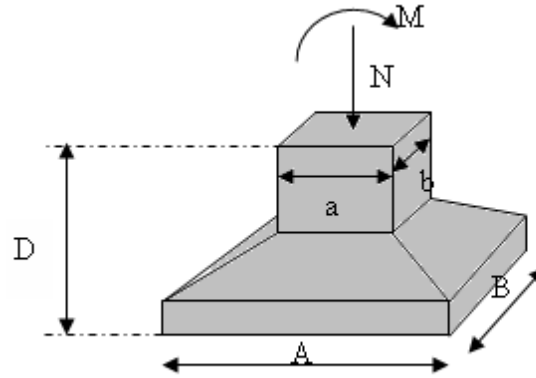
Schéma des Semelles isolées sous poteau.
